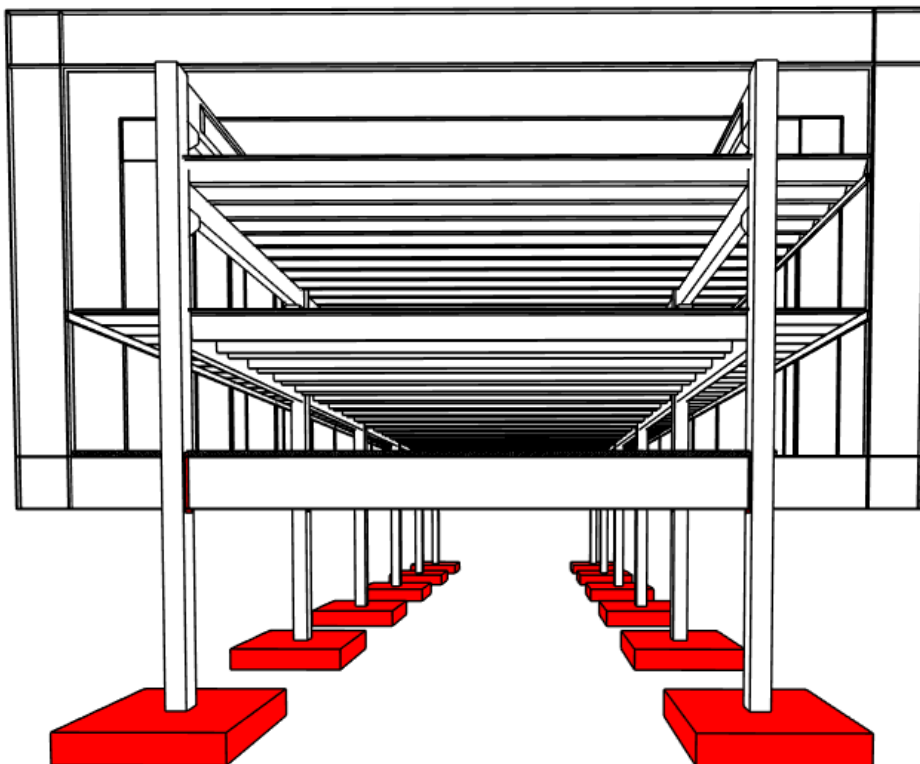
Ubicación de las zapatas aisladas de H°A°. Fuente: Autor.
